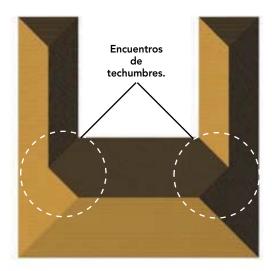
Vista en planta de una techumbre, donde se aprecian dos encuentros de techumbres.
